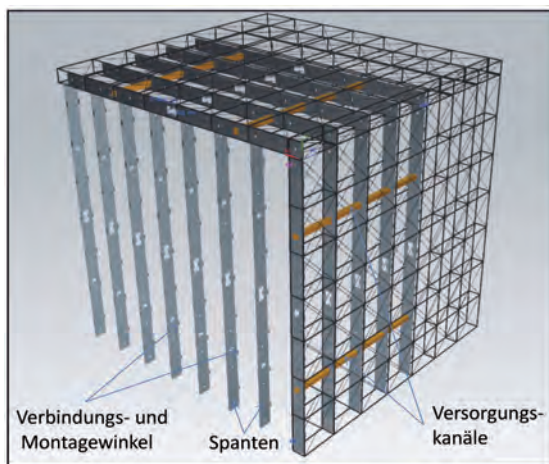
Wand- und Deckenkonstruktion in Spantenbauweise
